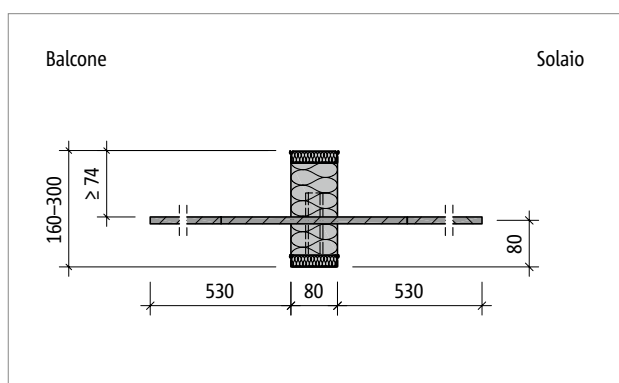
Schöck Isokorb® T tipo HP-NN2: sezione dell'elemento
